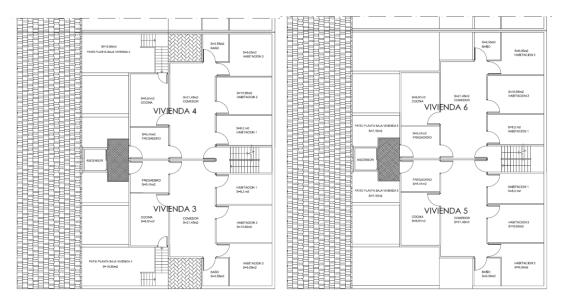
Accesos desde escalera y ascensor en patios a viviendas planta Primera y Segunda Propuestas.
